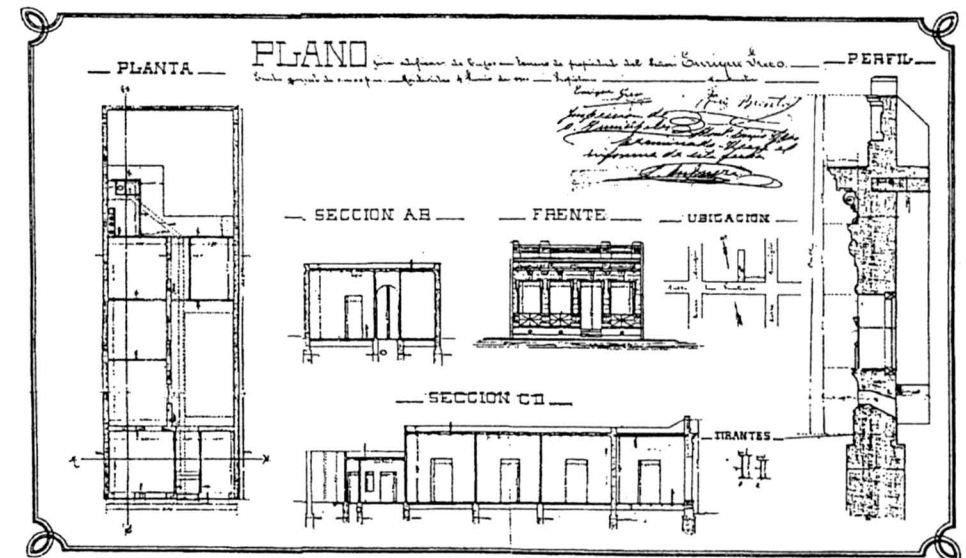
Permiso de Construcción. Casa standard. Constructor: Feliz Brenta. San Fructuoso entre Guaviyú y Casupá. Año 1900.
